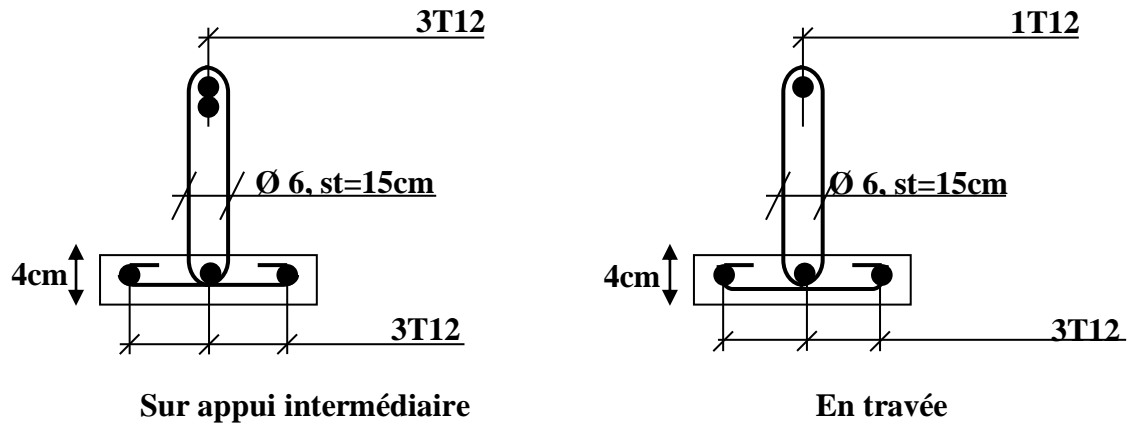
Schémas ferrailage des poutrelles Plancher Terrasse.
